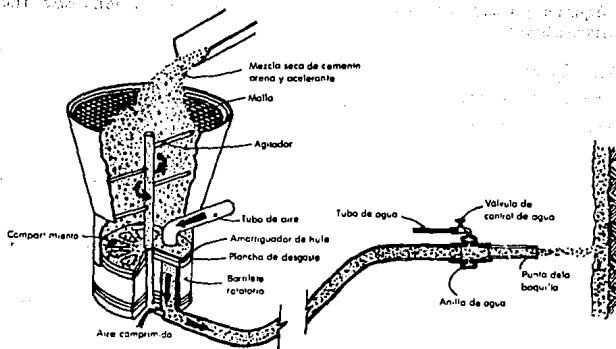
Funcionamiento característico de una máquina para concreto lanzado de mezcla seca.
